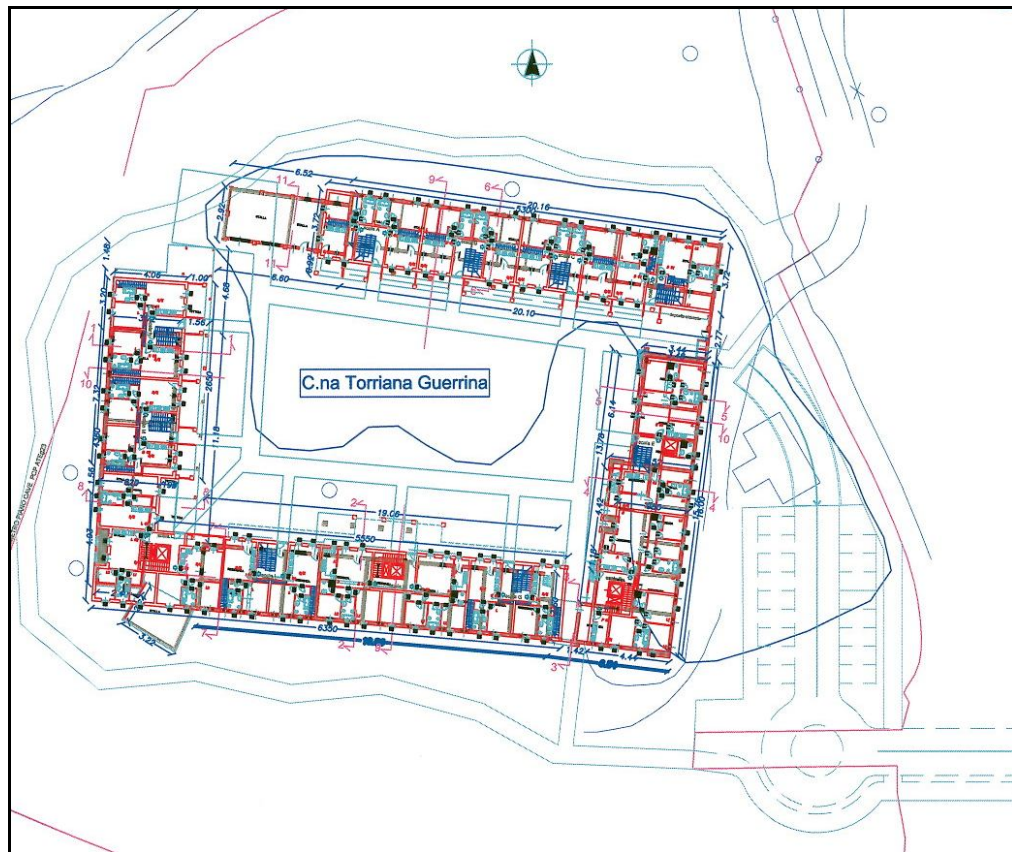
Sovrapposizione planimetria s.d.f. – s.d.p.
